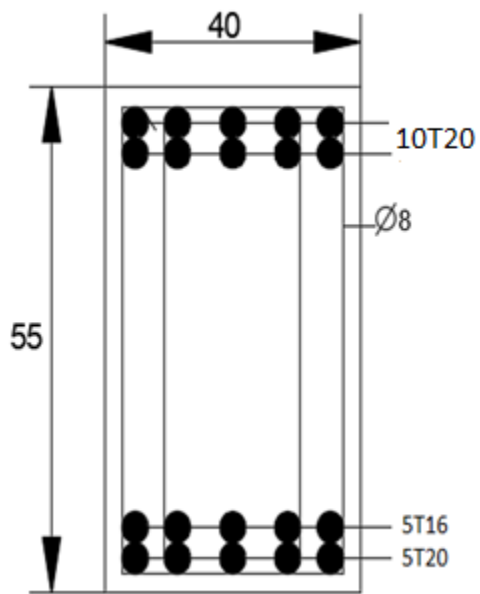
Dessin de ferrailage des poutres dans le sens transversal de rive
